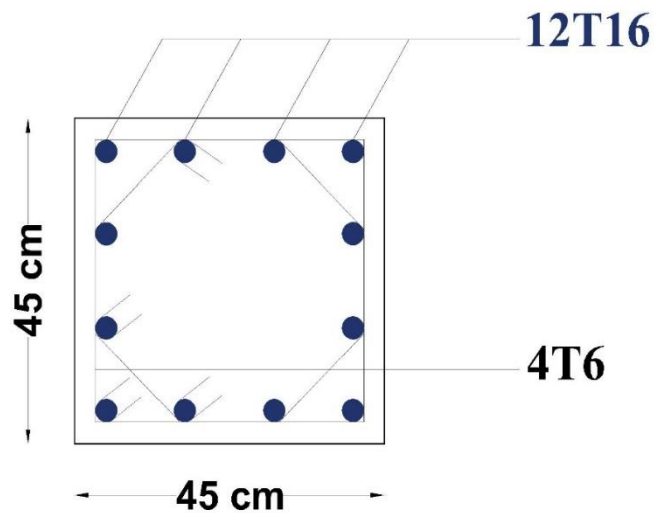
Ferrailage des poteaux des sous-sol (partie 2)
